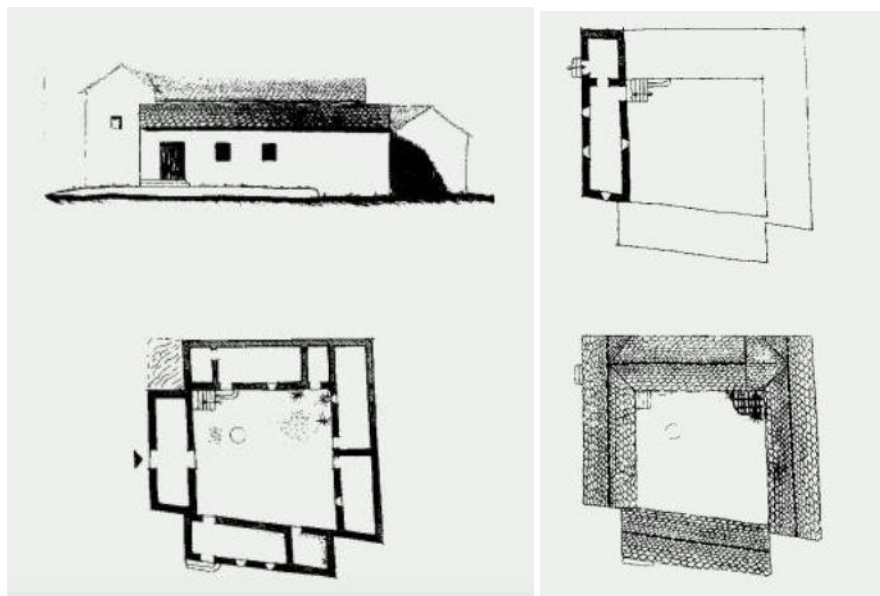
plantas y alzados de una casa compuesta en Ait lakova-marruecos.
